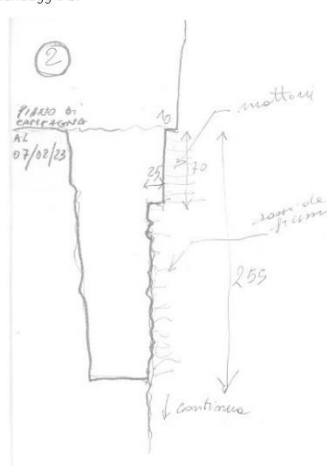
Sondaggi fondali (foto e disegni dell'Arch. Davide Cristofani – Studio Magaze - Faenza)
